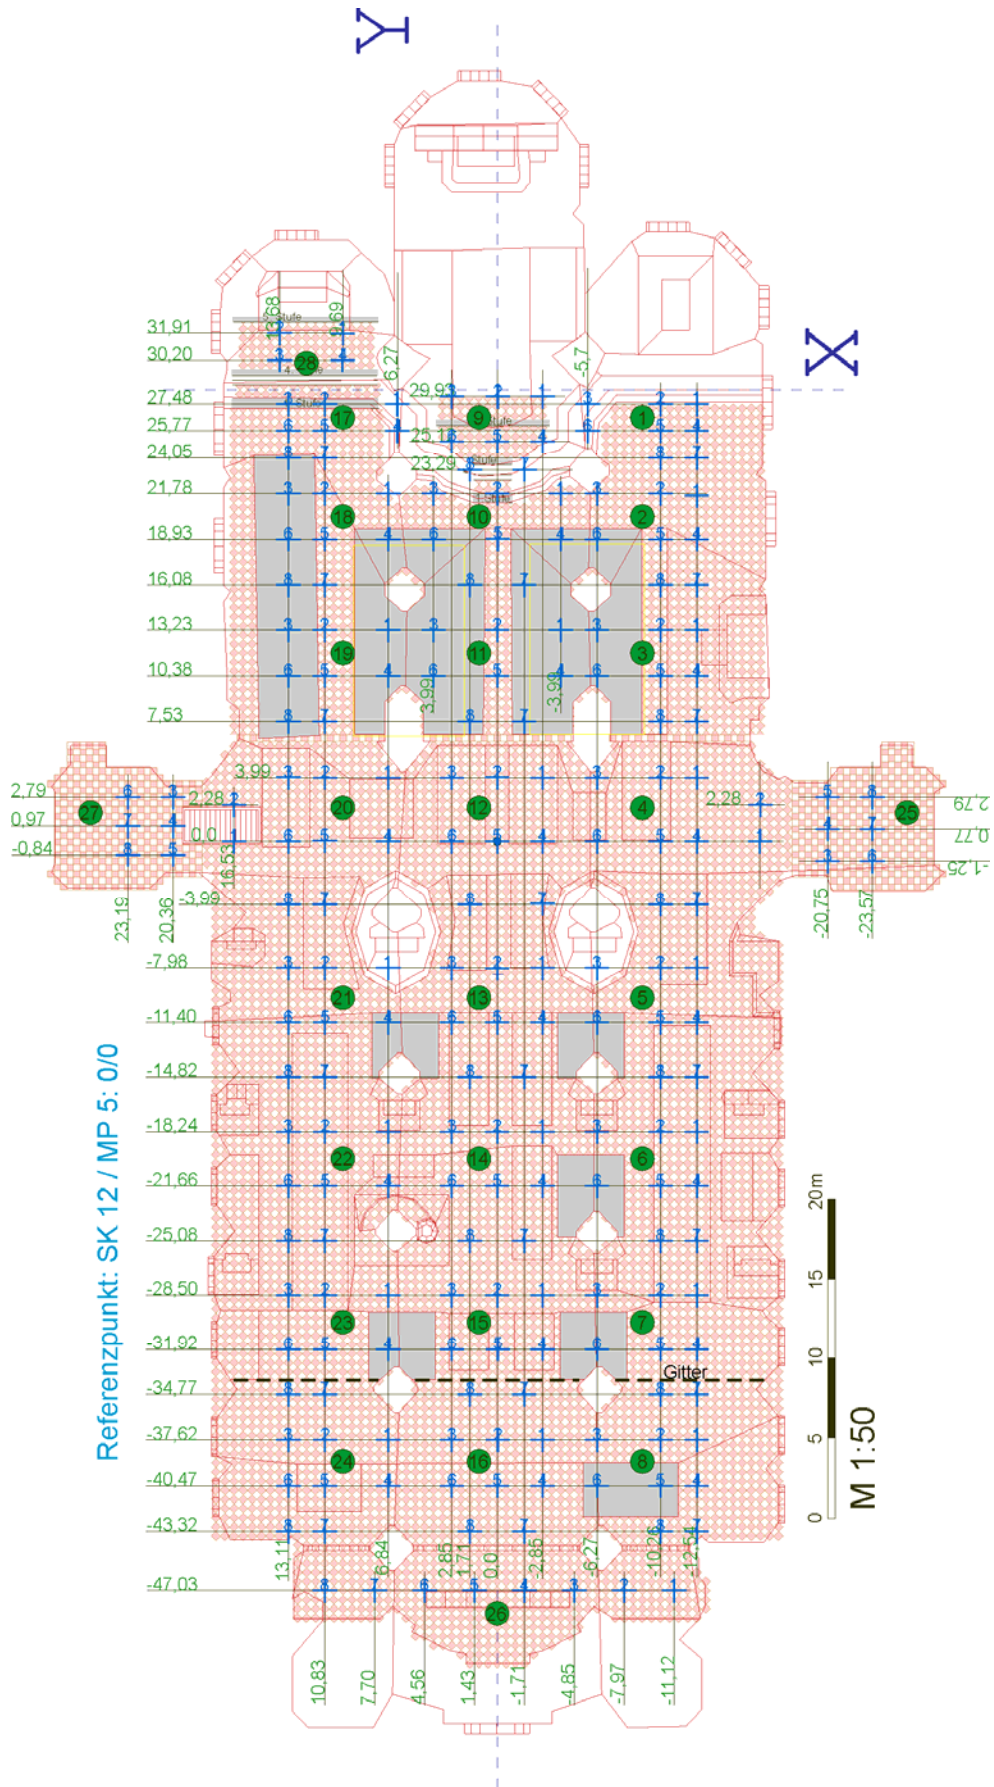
Grundriss Stephansdom, Messpunkte
